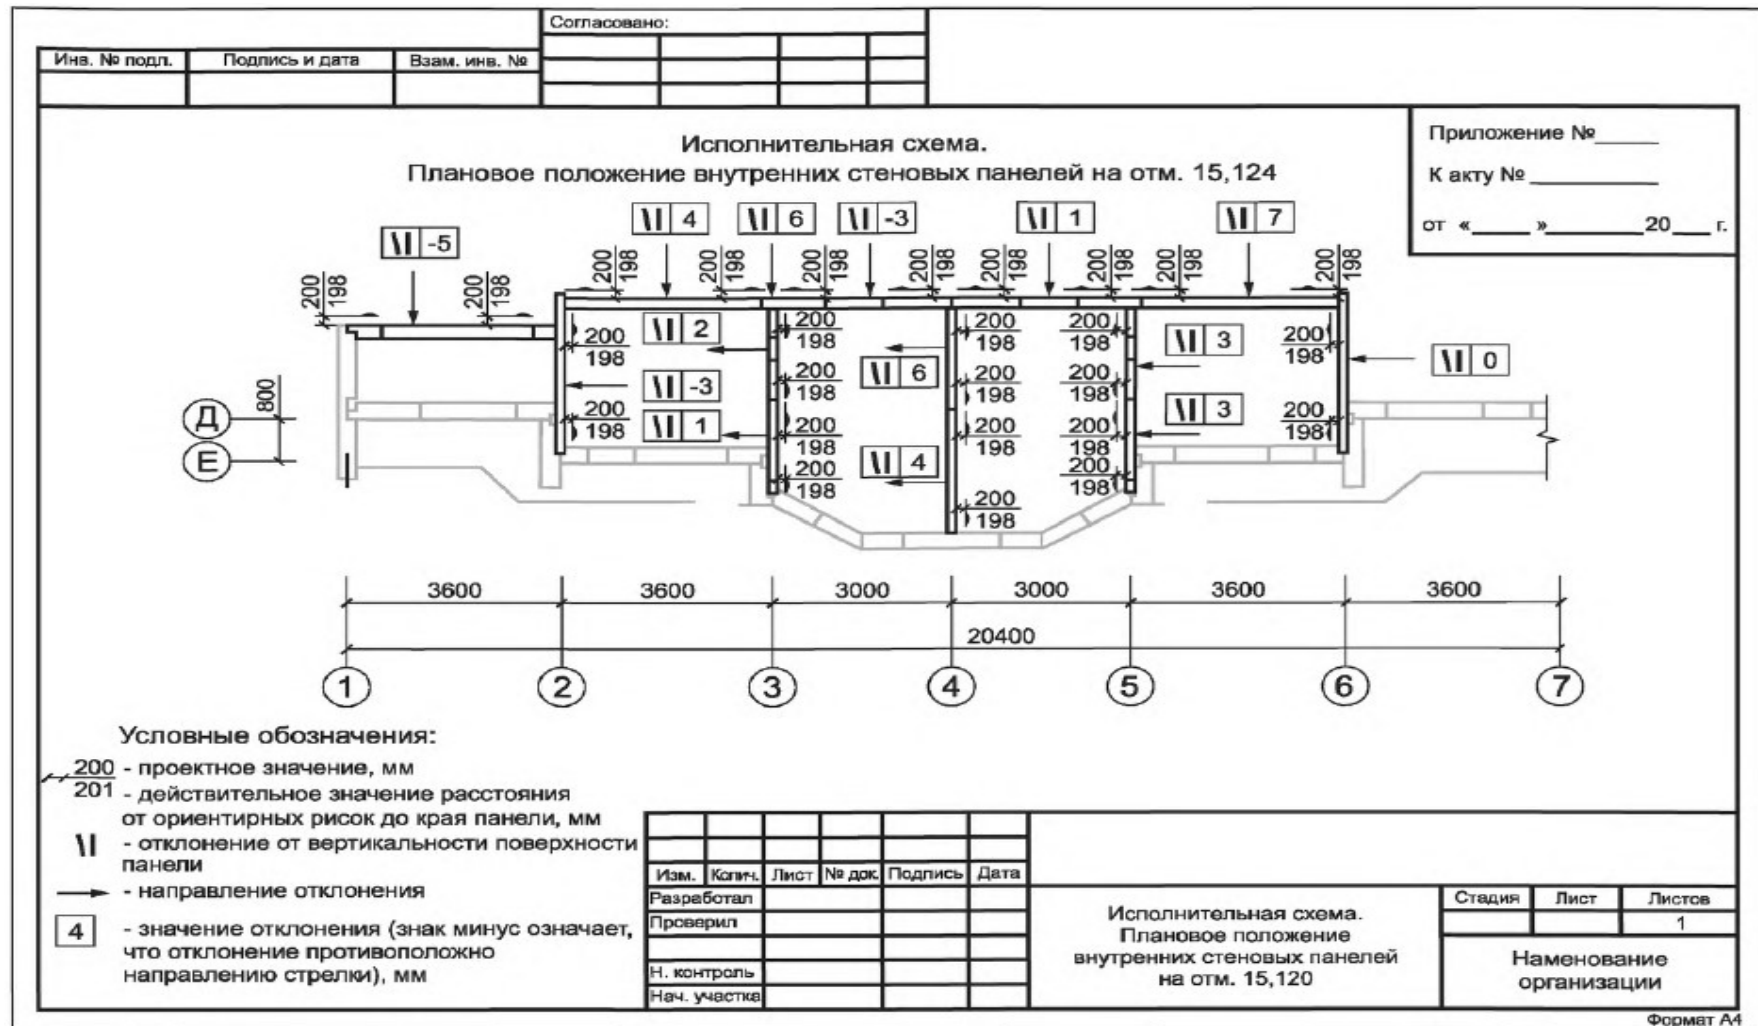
Исполнительная геодезическая схема. Внутренние стеновые панели этажа жилого дома (плановое положение)
